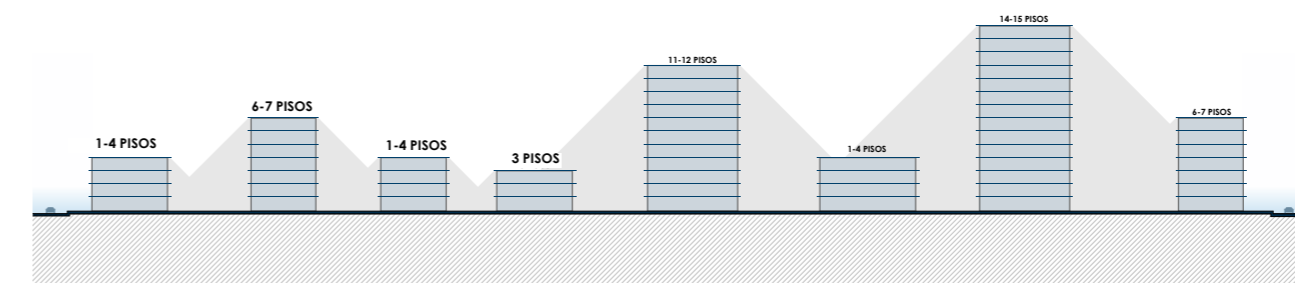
Sección transversal de Manzana (alturas). Fuente: Autoría propia (2026)
